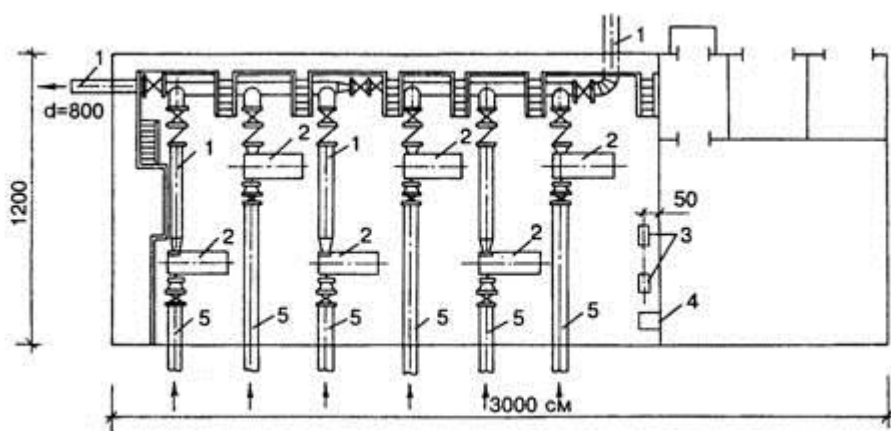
Схема насосной станции с двухрядным расположением агрегатов
